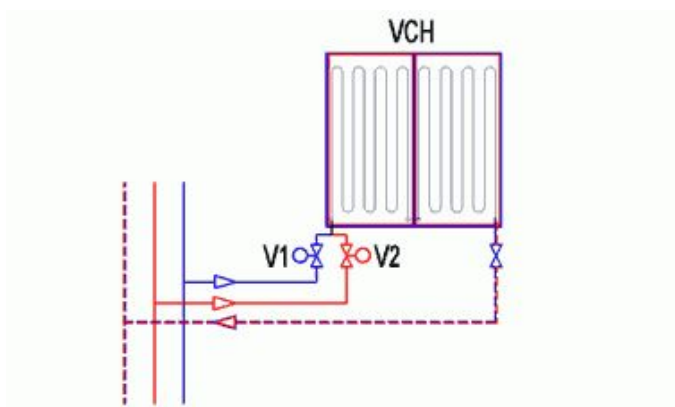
Dvoutrubkový systém zapojení [26]
